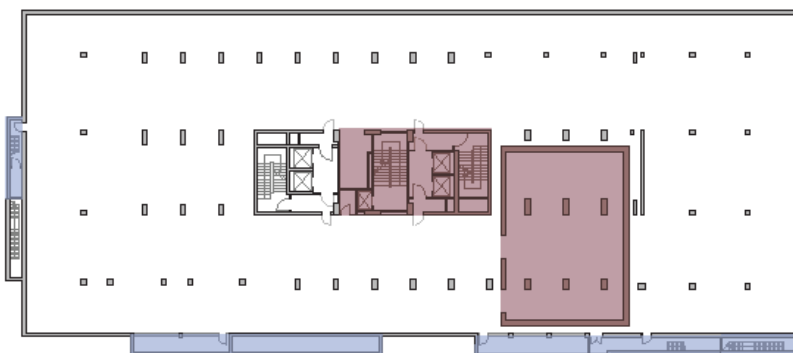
Progetto strutturale esecutivo. Pianta secondo interrato (Integrazione del 03/09/87)
